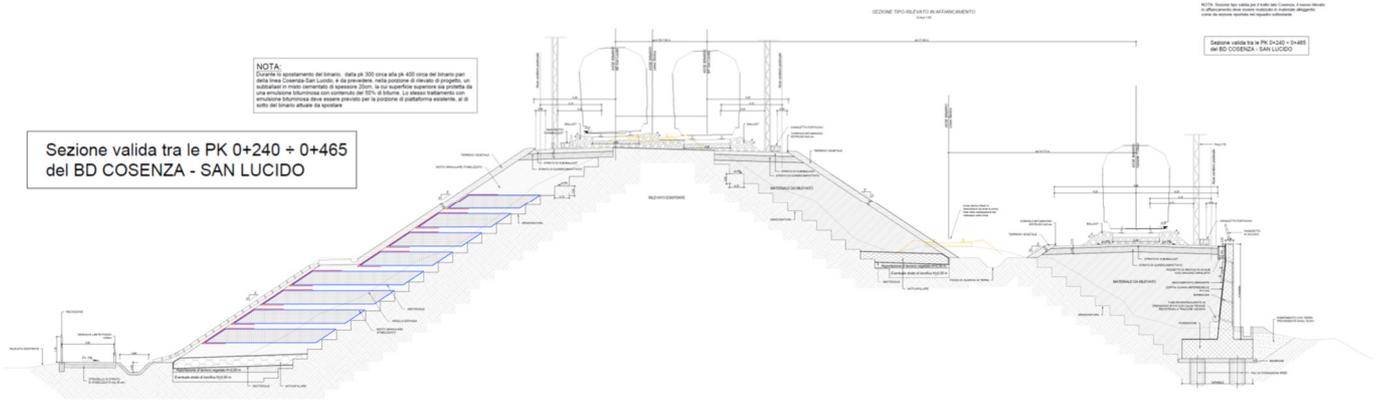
Sezione tipo in rilevato alleggerito a doppio binario in affiancamento
